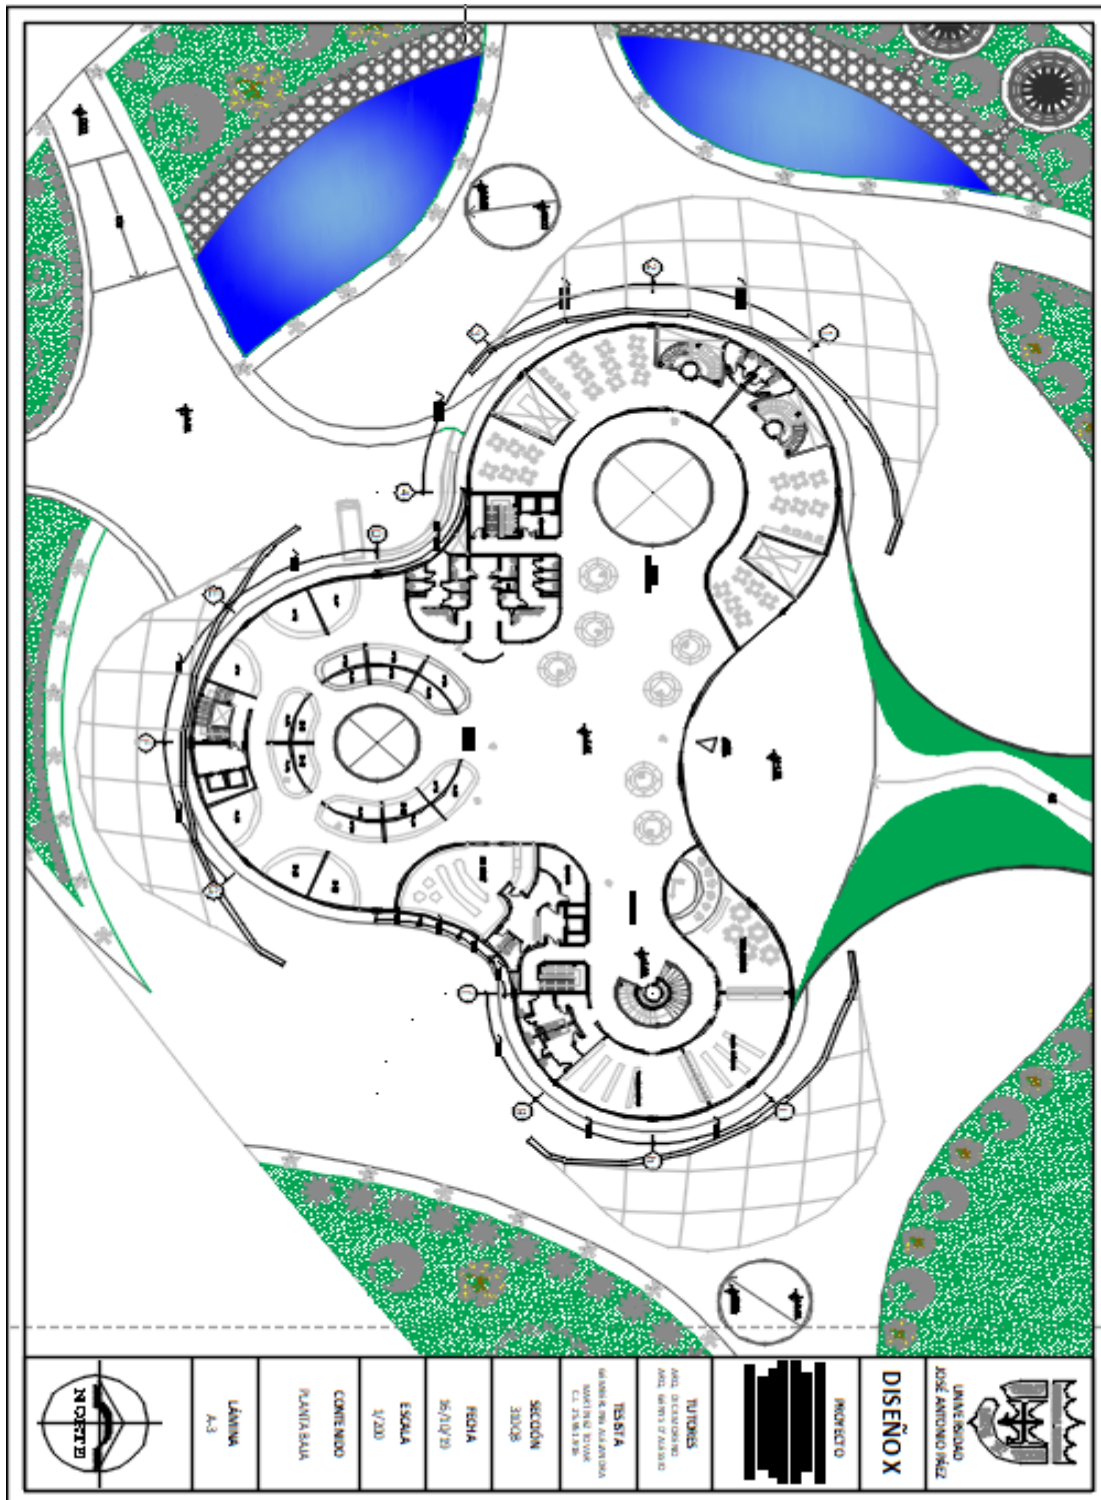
Planta Baja. Autor: Gemberling Martínez (2018)
